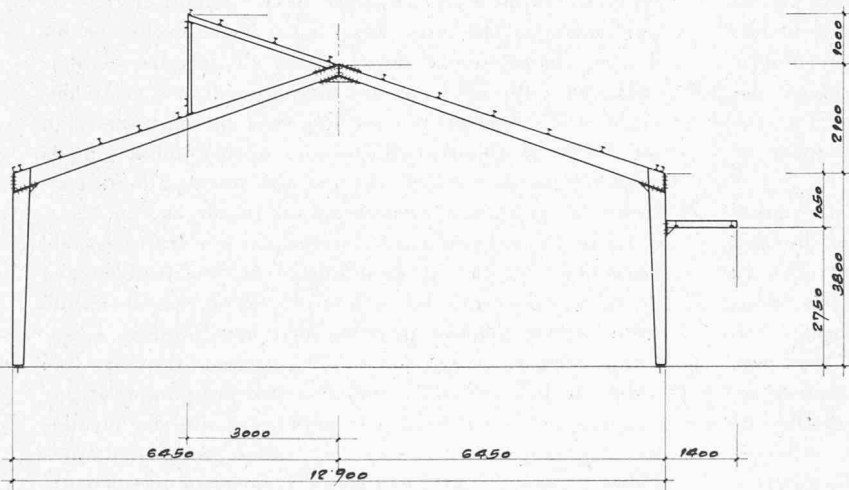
Entrepôt Migros. Coupe en élévation.
